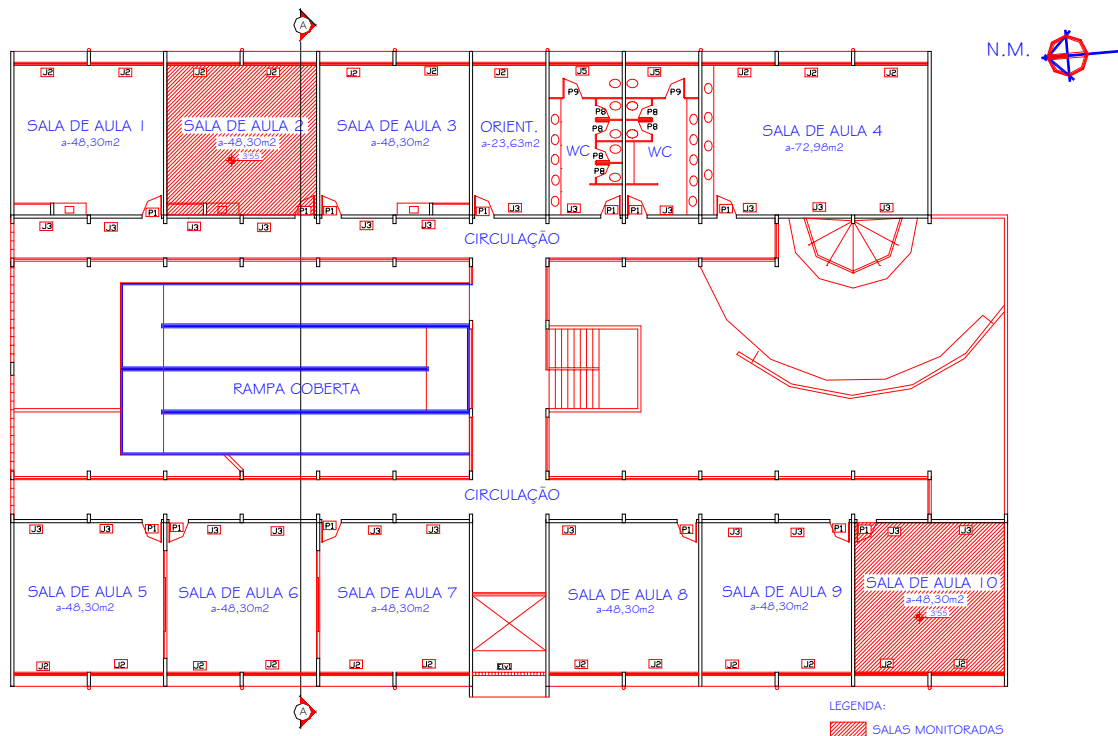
Planta-baixa do pavimento superior da Escola Donícia Maria da Costa (Fonte: FLORIANÓPOLIS, 2001)
